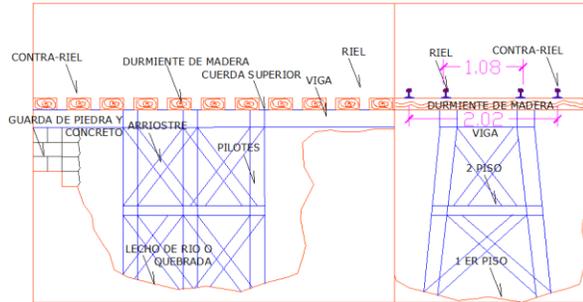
Detalle frontal y perfil de puente. (Fuente: Autor)
